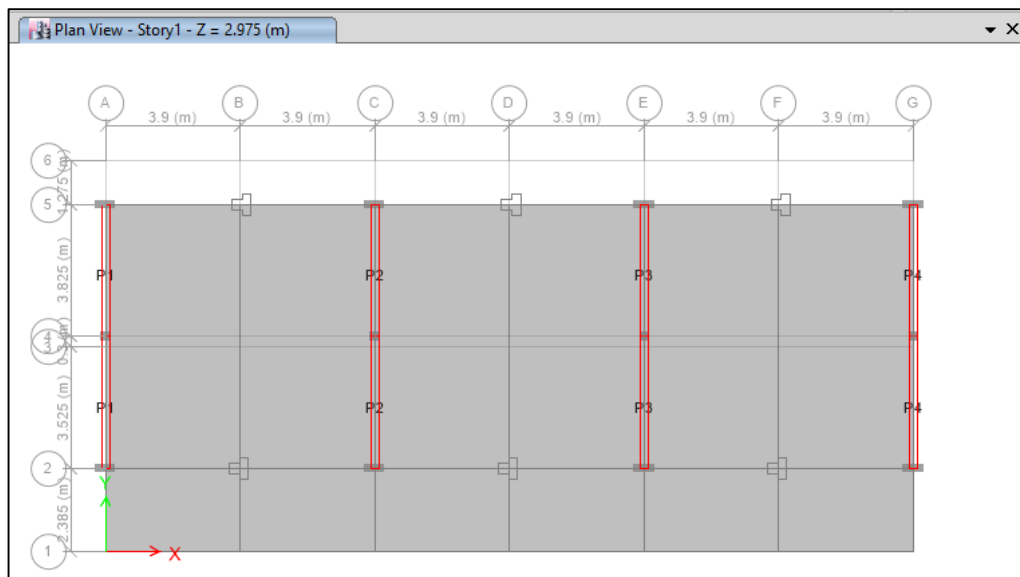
Etiquetas de cada muro de albañilería confinada.
